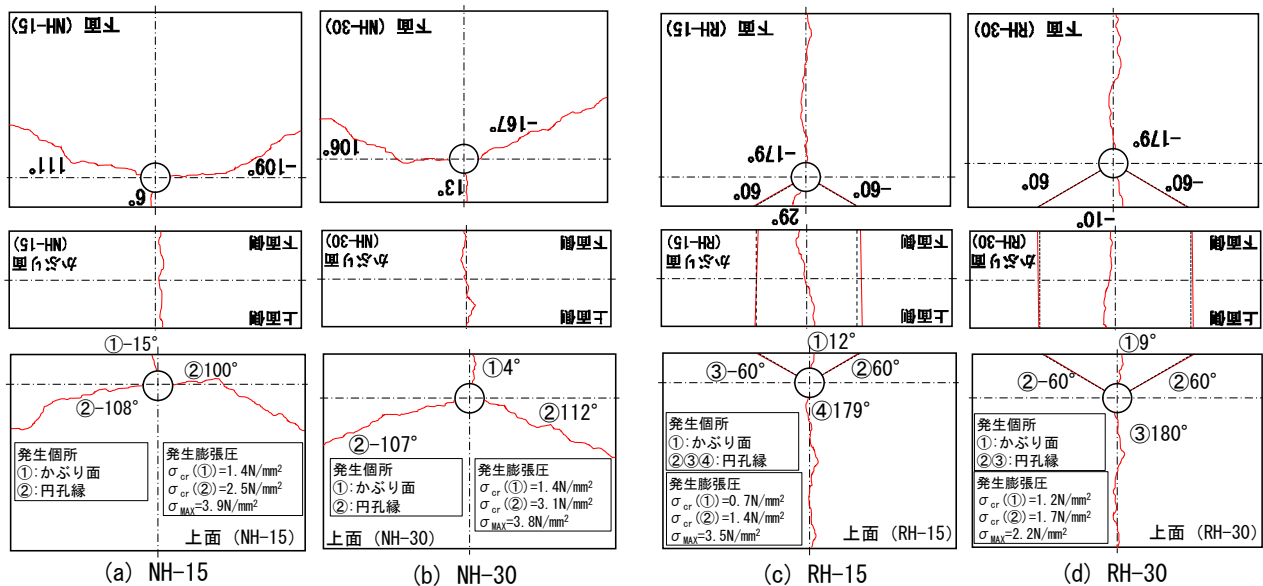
半面腐食時のひび割れおよび剥離状況 (シリーズ B)
